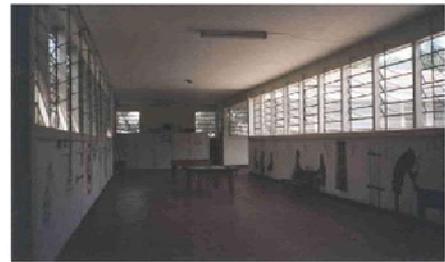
Foto da Ventilação no 2º pavimento da edificação
